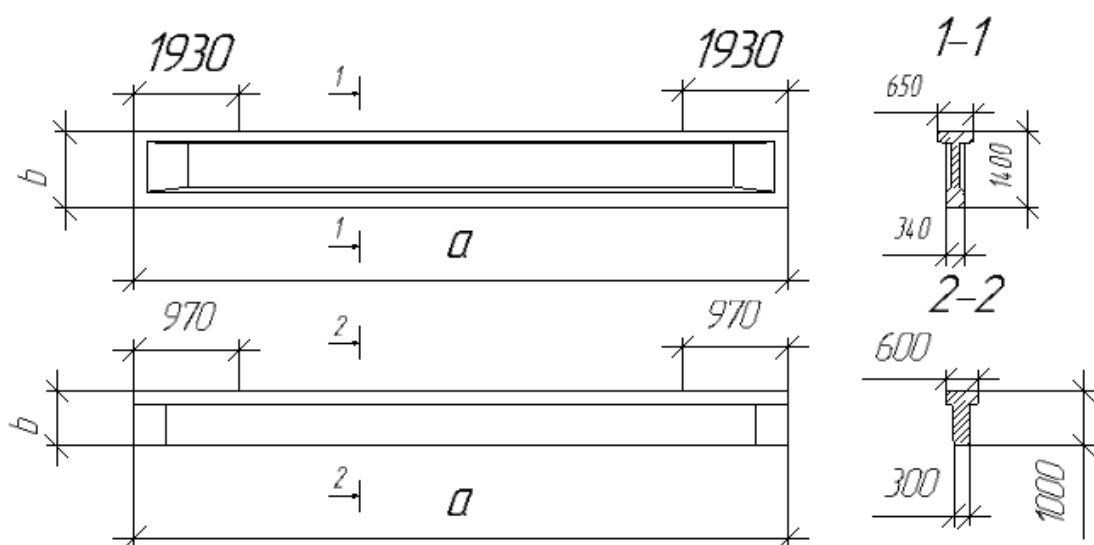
Залізобетонні балки по серії 1.426.1-4
